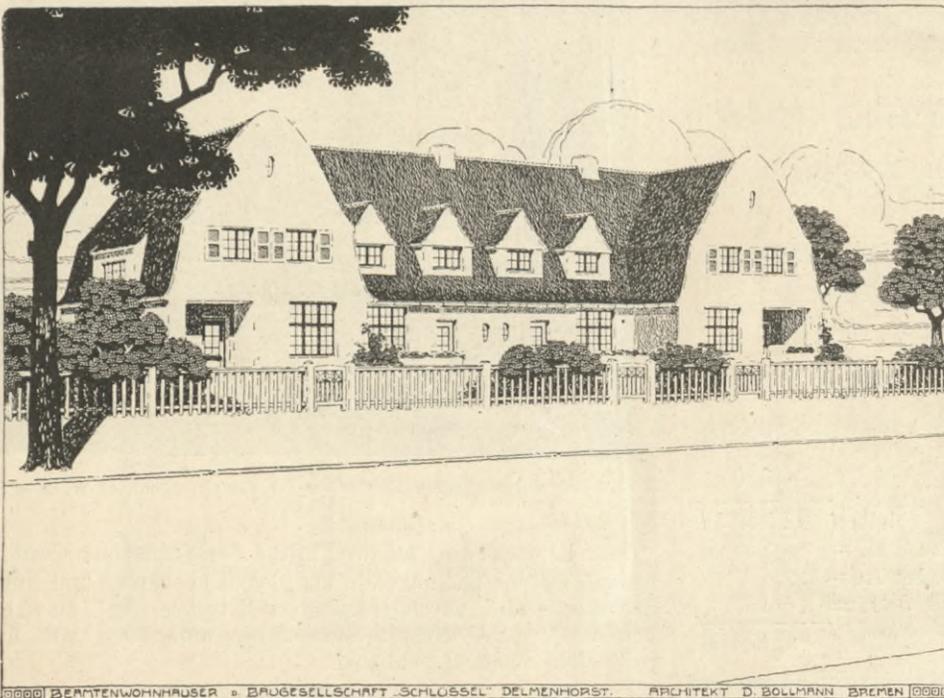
Beamtenhaus für Delmenhorst. Architekt D. Bollmann, Bremen
